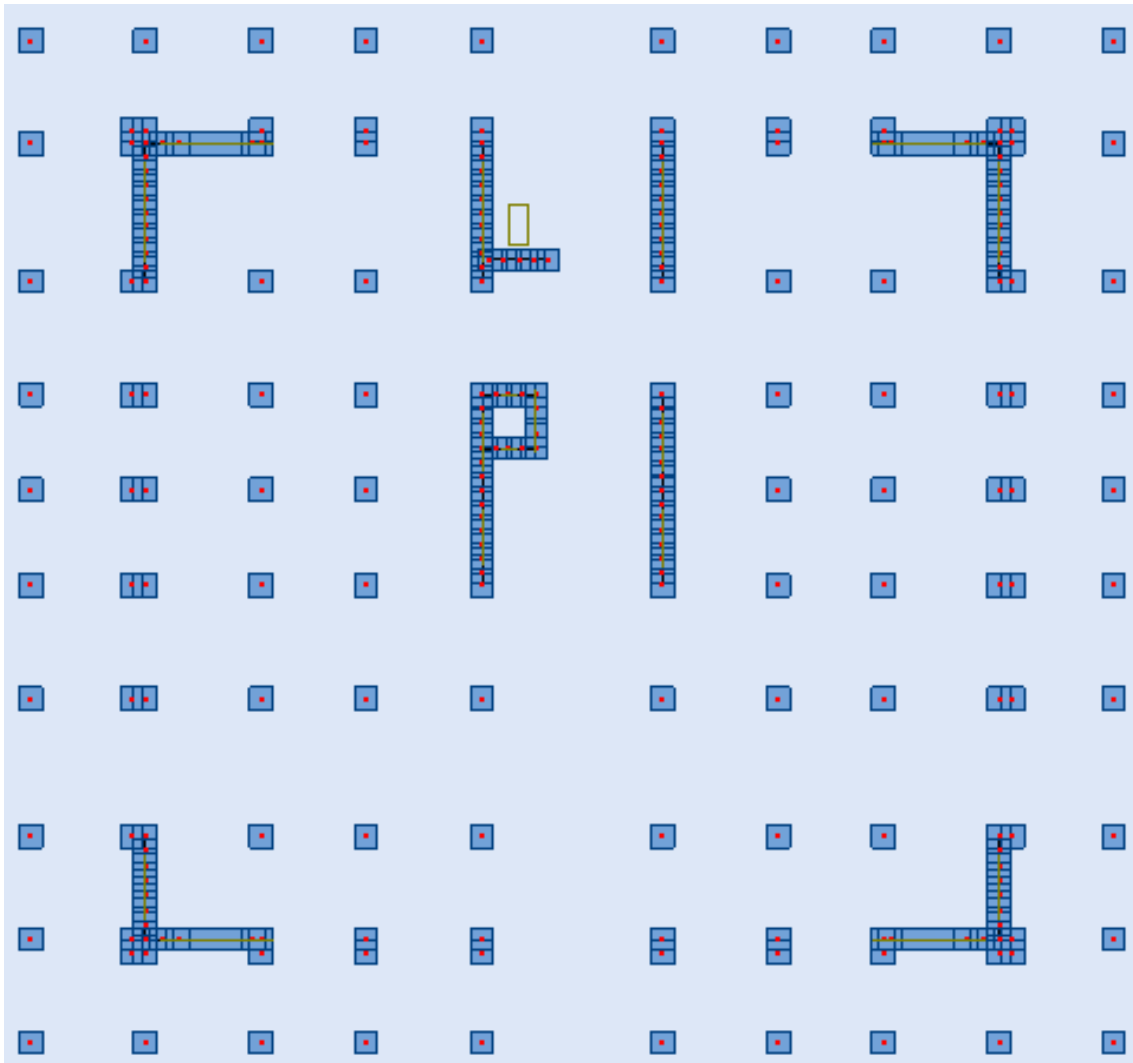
La 3<sup>me</sup> disposition des murs voiles (voile20) et poteaux.
